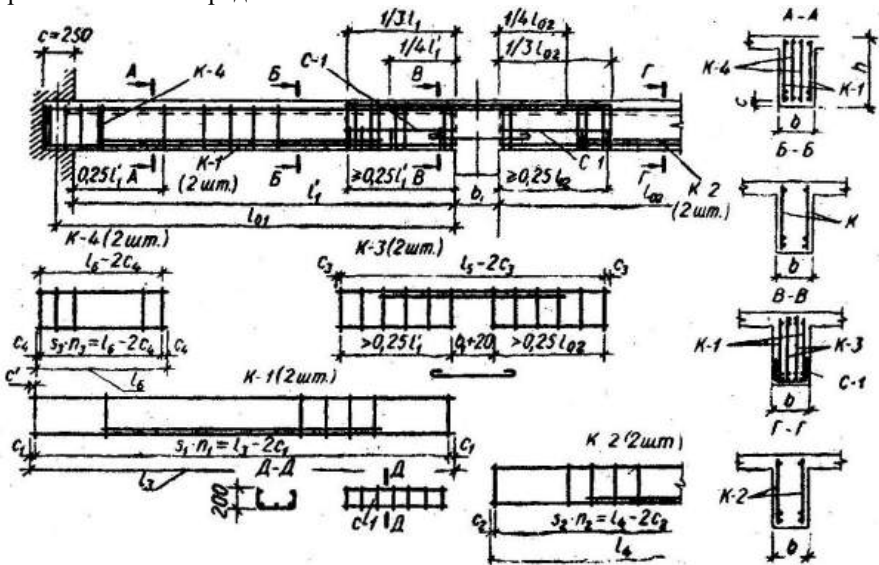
Армування другорядних балок зварними каркасами в прольотах і на опорах: 1...4 – номери стержнів
